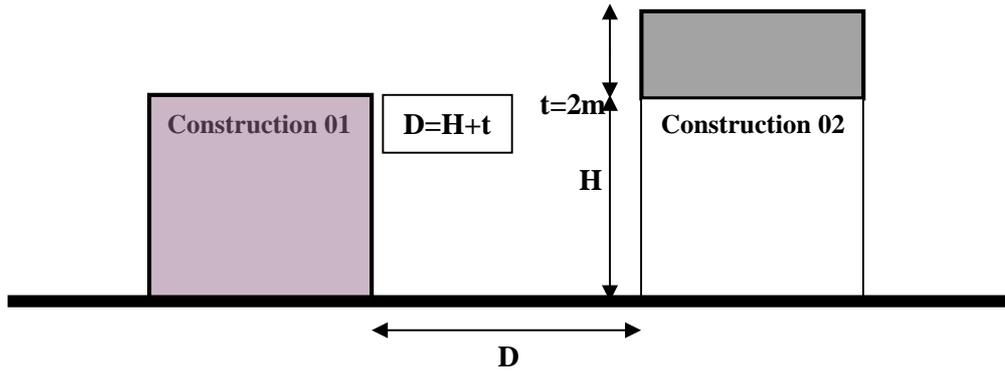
Coupe définissant la tolérance sur la hauteur d'une construction en bordure d'une voie
